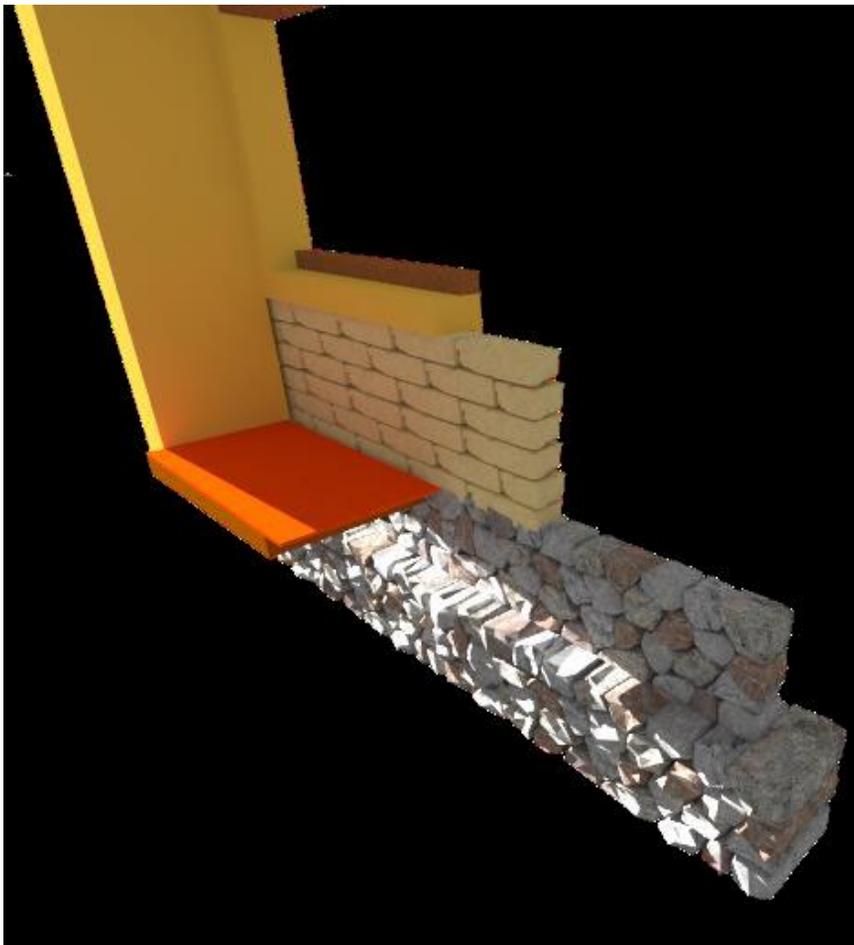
Detalle de muro mixto. Elaborado por el autor
